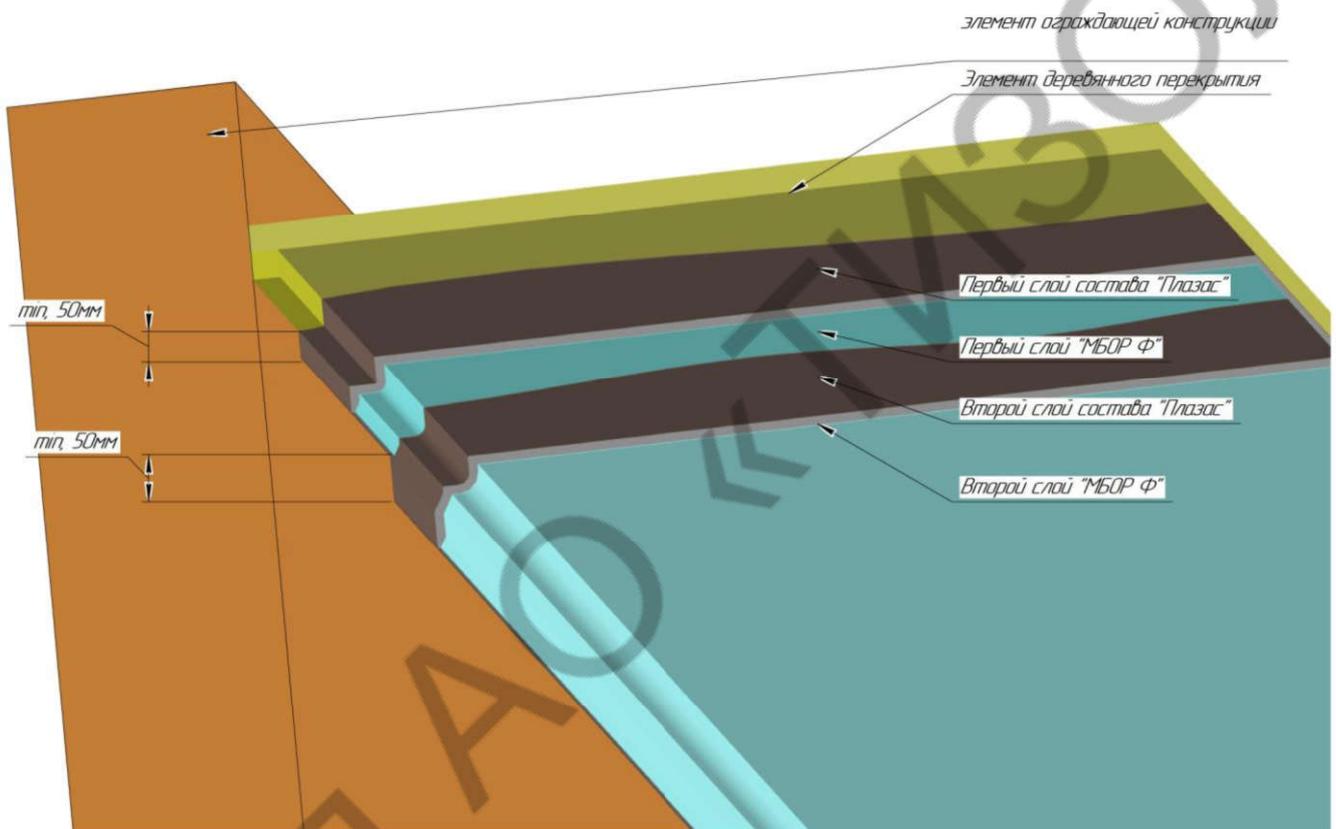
Монтаж системы «ЕТ ДРЕВО» на деревянное перекрытие.
